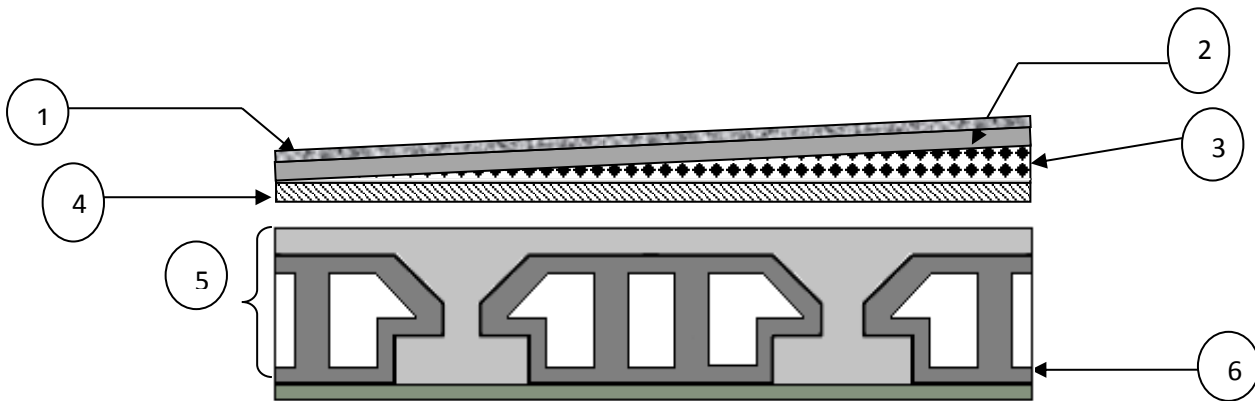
Coupe transversale d'un plancher terrasse inaccessible
